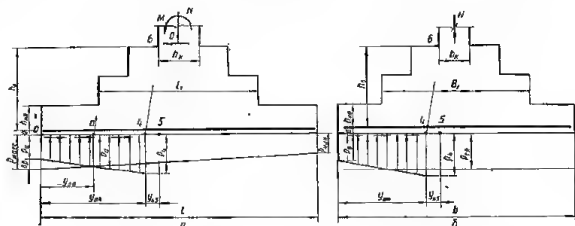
К расчету ступенчатого фундамента на изгиб:
